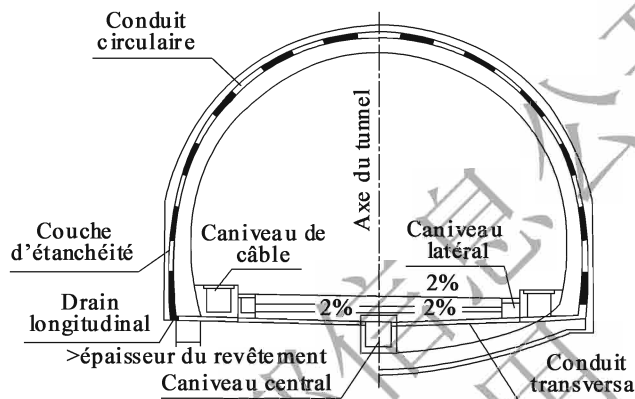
Schéma du profil du système de drainage du revêtement de tunnel
